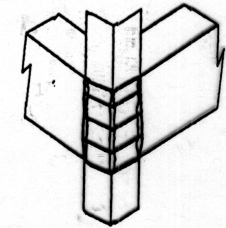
T, Daños en Uniones de Columnas y vigas.
